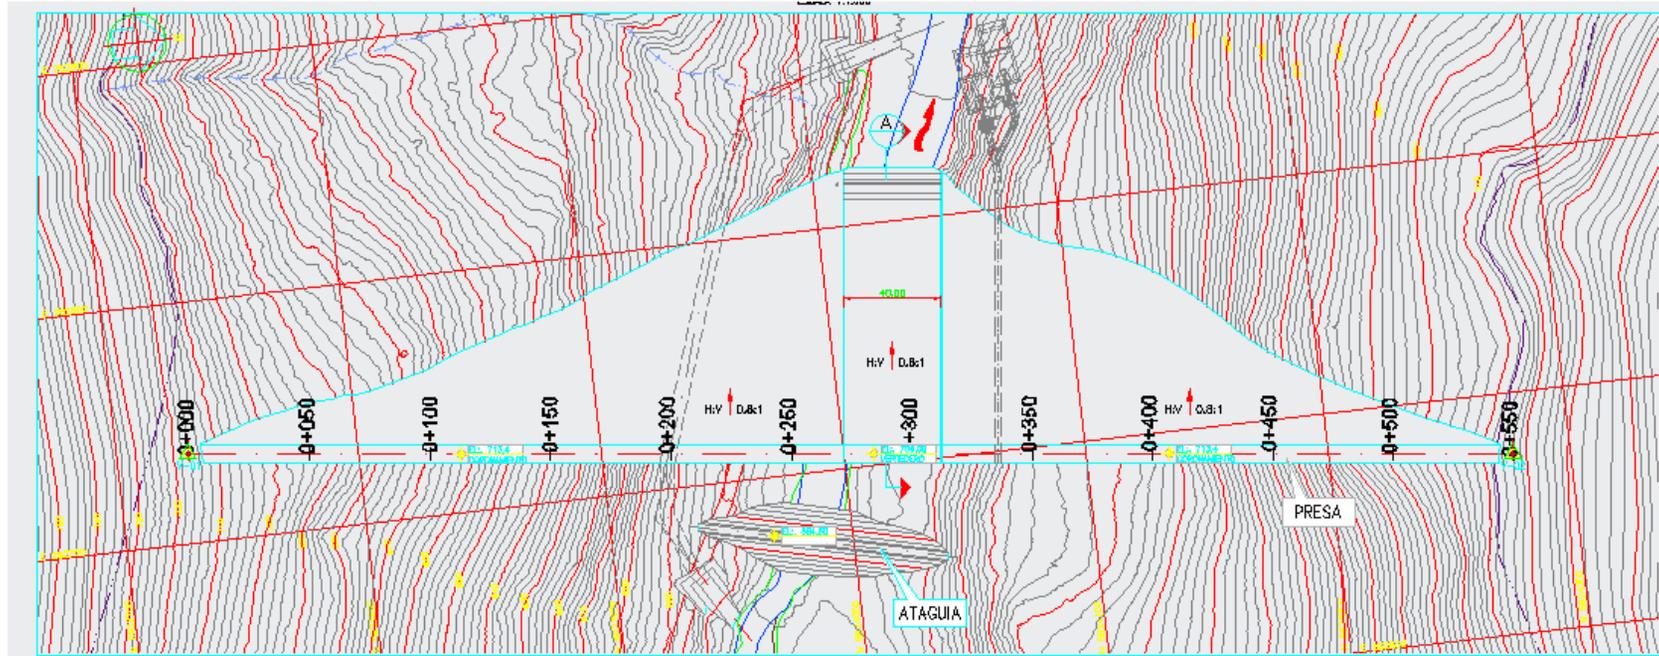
Perfil topográfico longitudinal del eje del muro.
